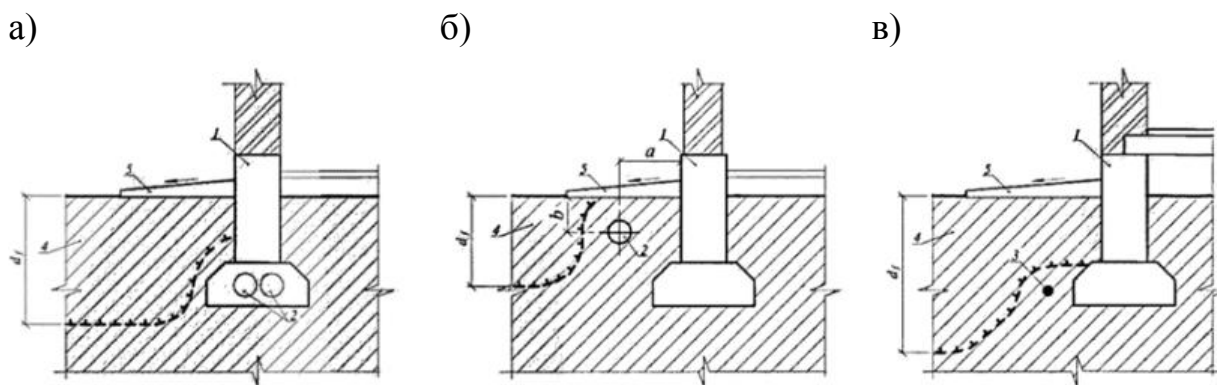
Схемы обогрева грунта. а - прокладка труб отопления в фундаментах;
